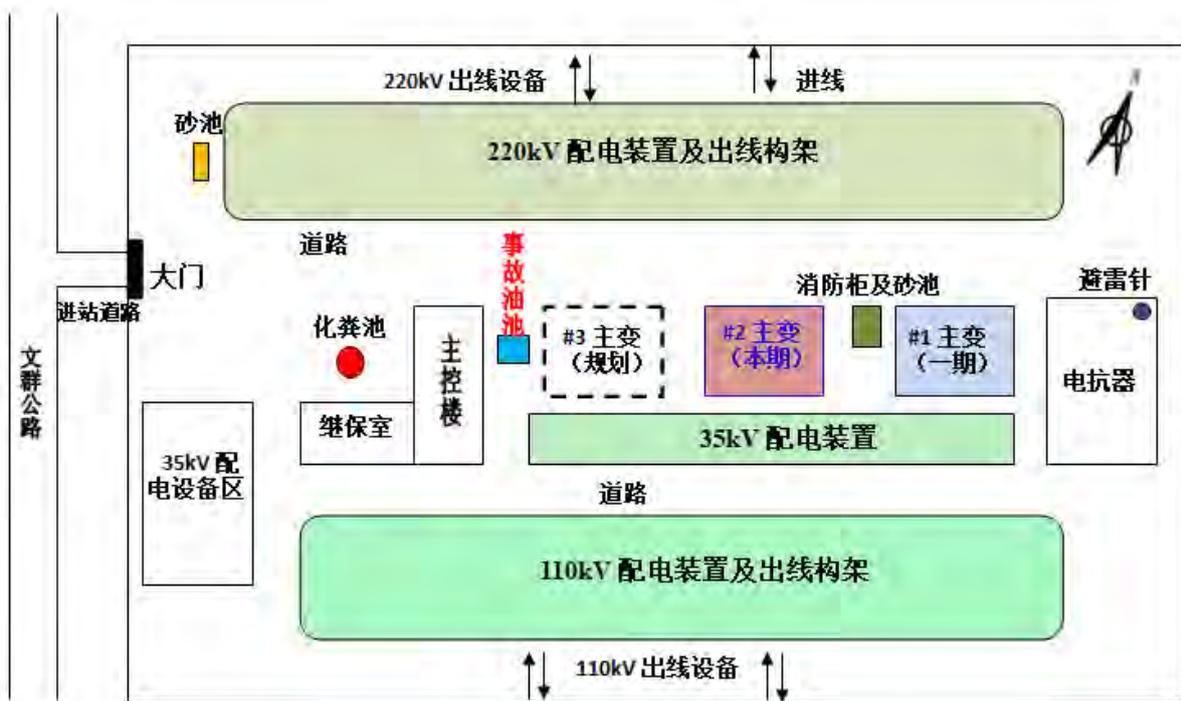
陵水文罗 220kV 变电站站区总平面布置图
